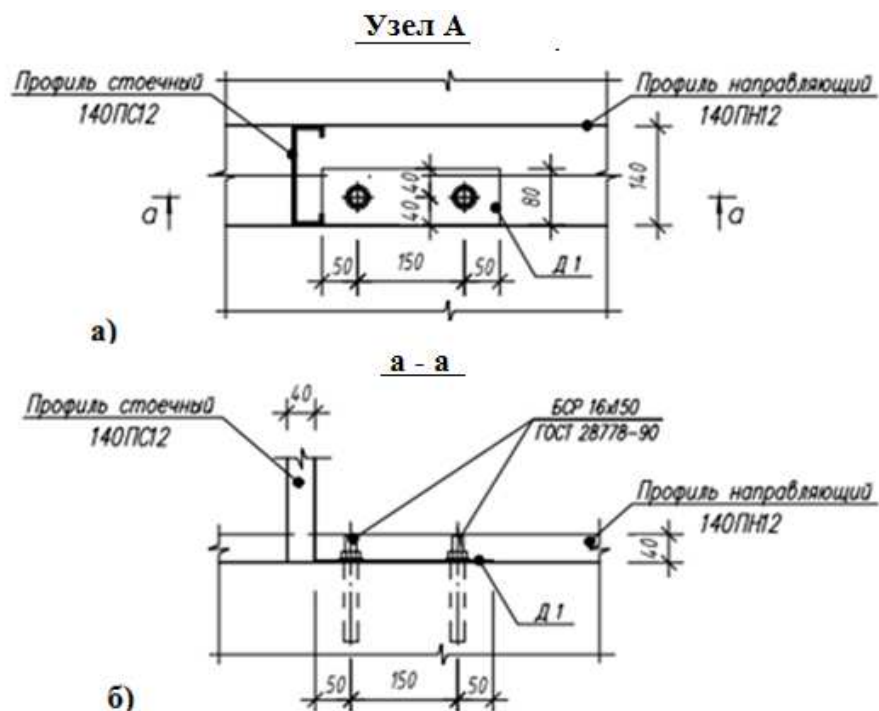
Общий план фундамента с расположением деталей крепления Д1
